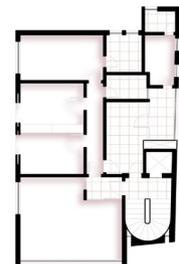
Edifício Condado de Luzerne, pavimento tipo. Fonte: FAGUNDES, 2021.
